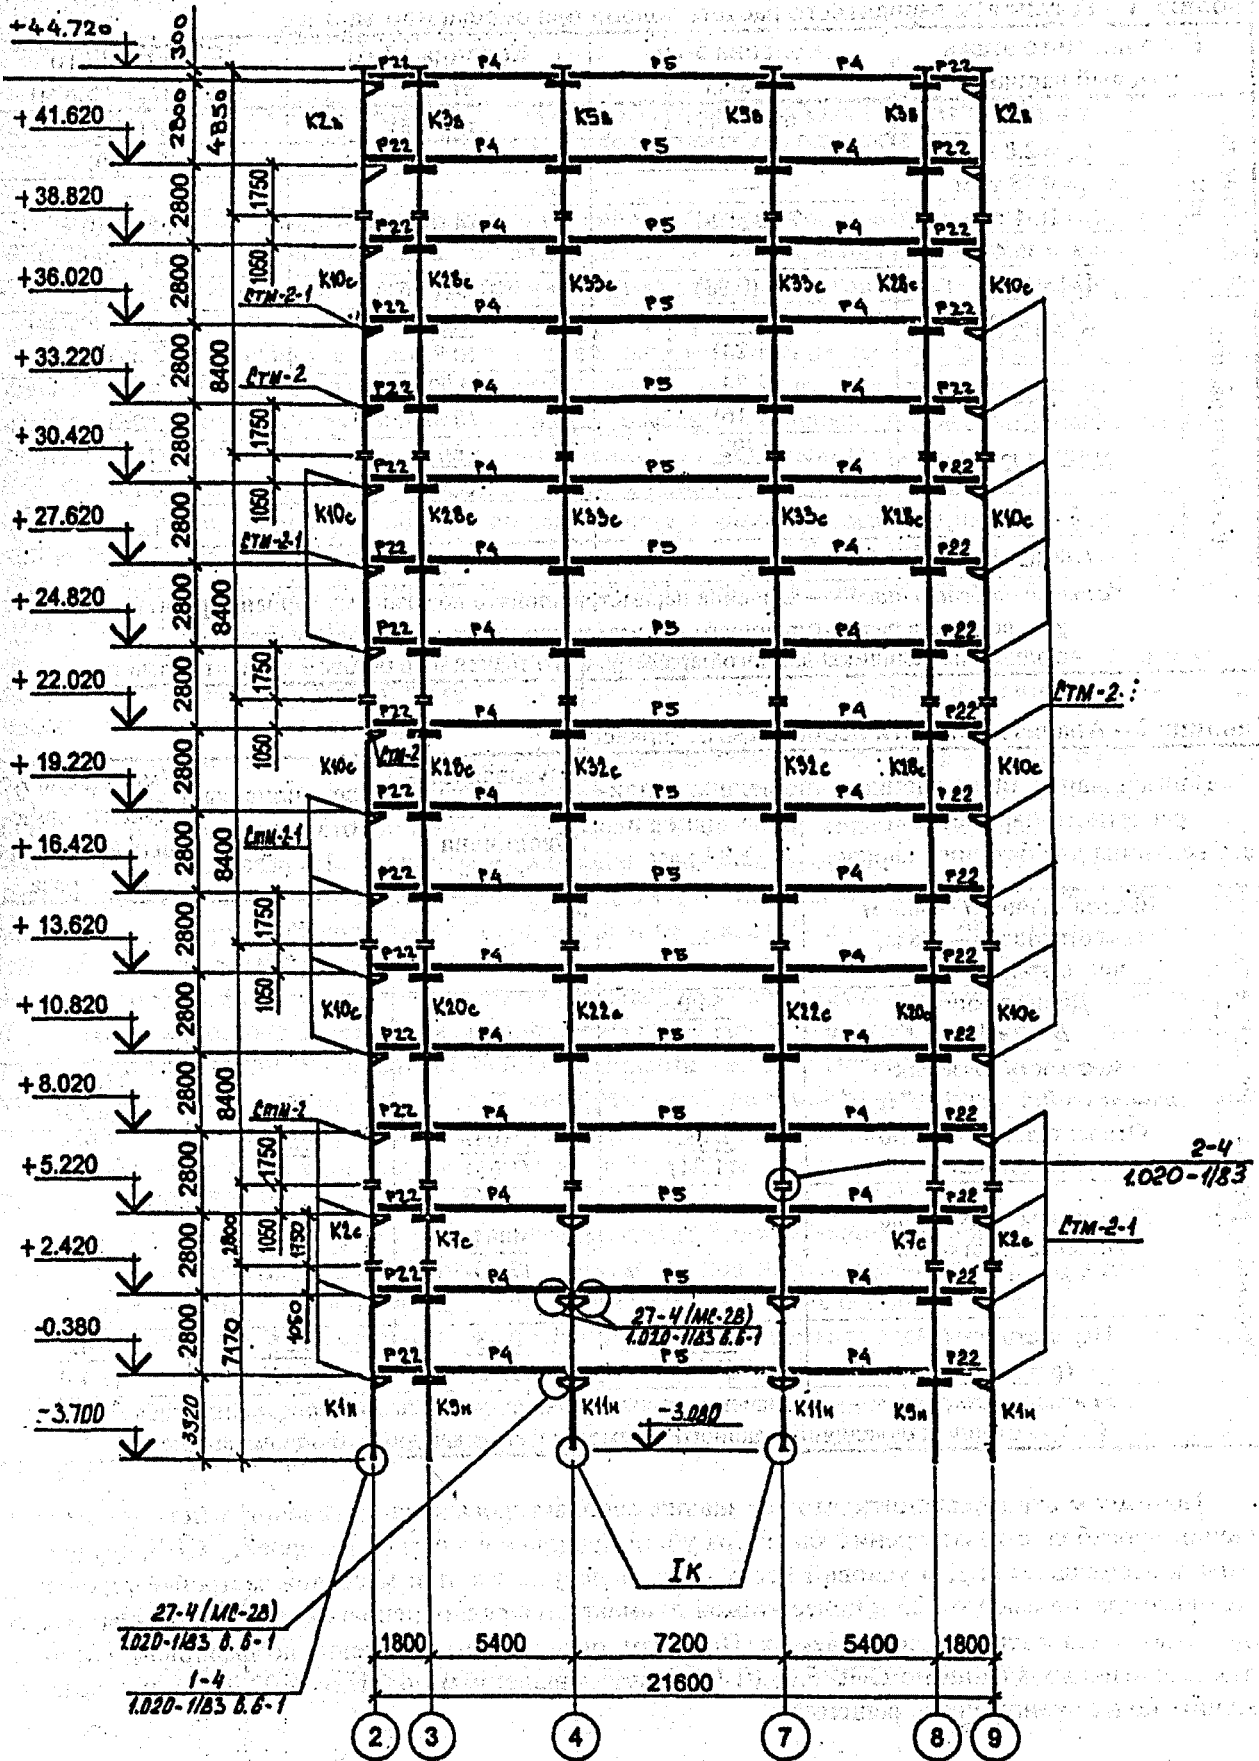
Монтажная схема колонн и ригелей каркаса. Разрез 6-6
